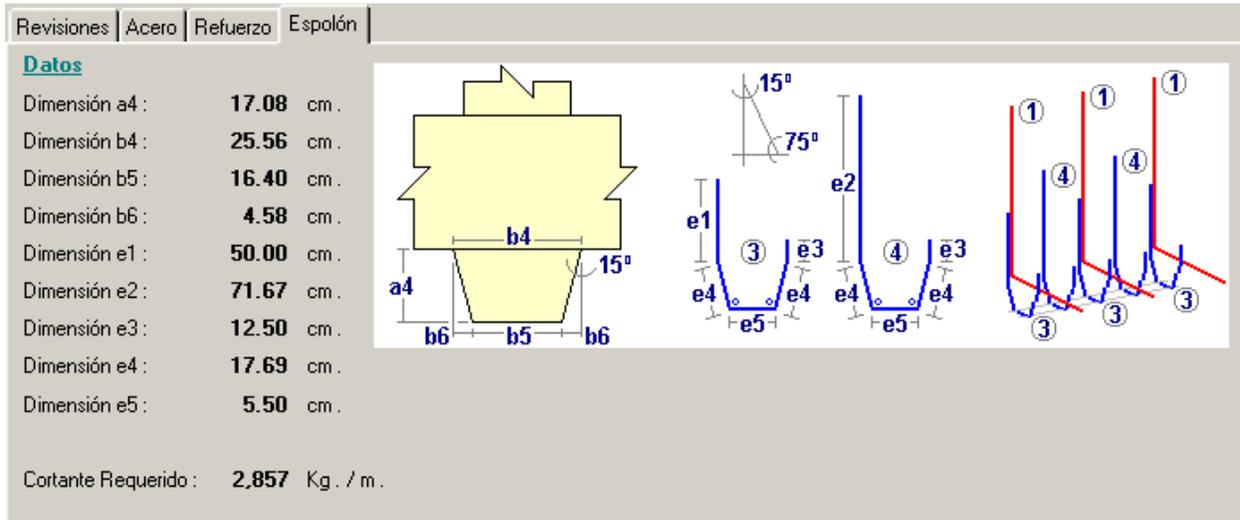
Cálculo de Muro Bajo en “T” con sobrecarga.
